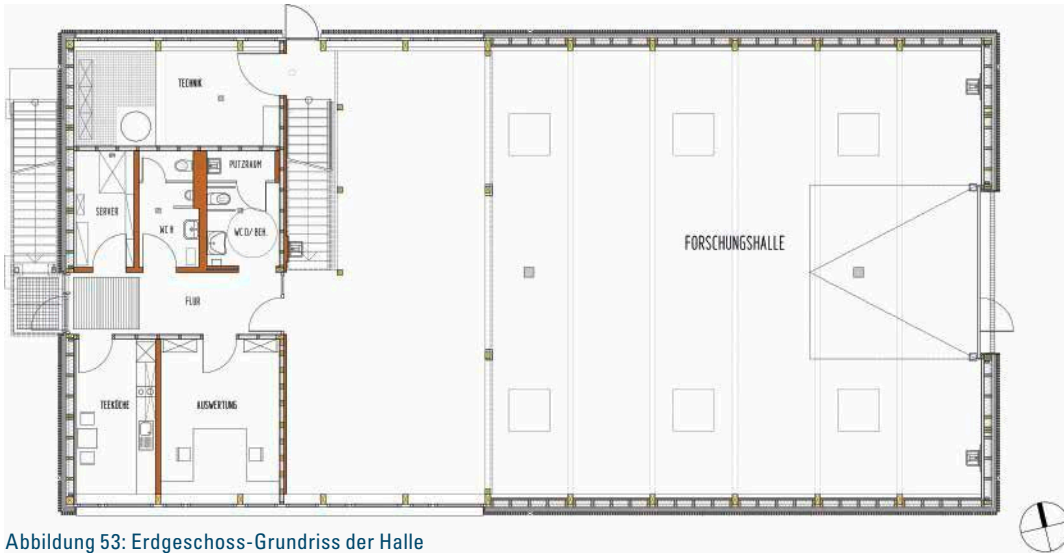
Erdgeschoss-Grundriss der Halle
